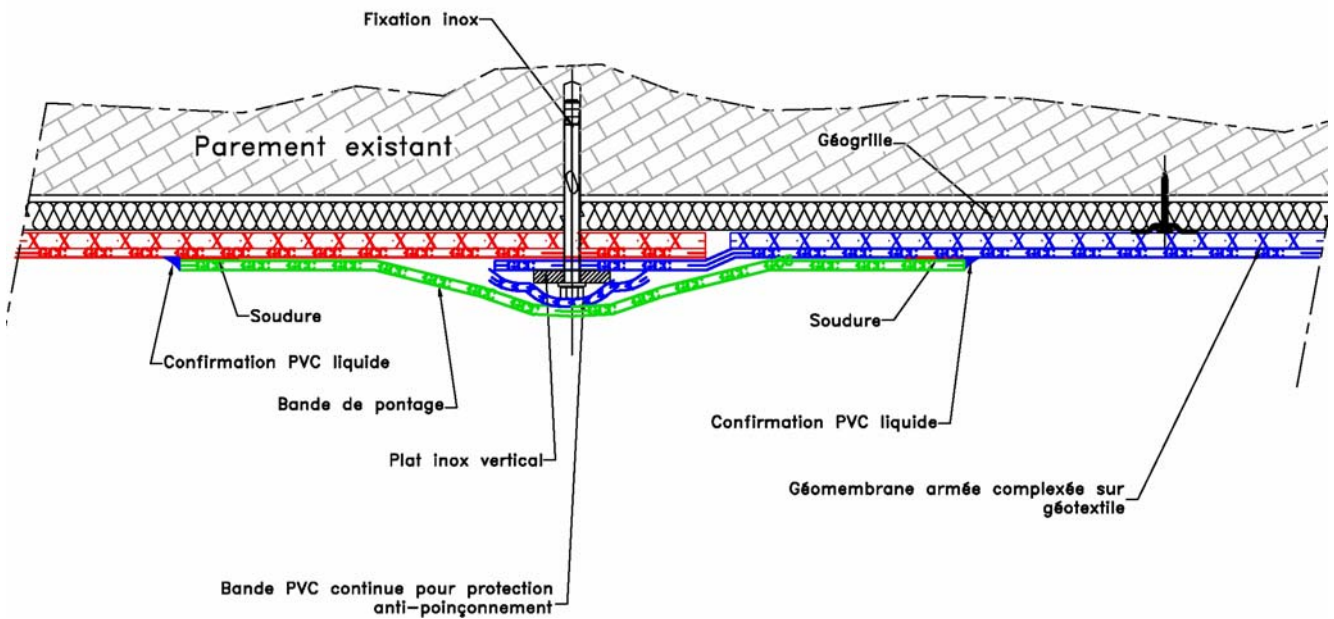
Etanchéité du Barrage de la Muratte, détails de fixation des lés
